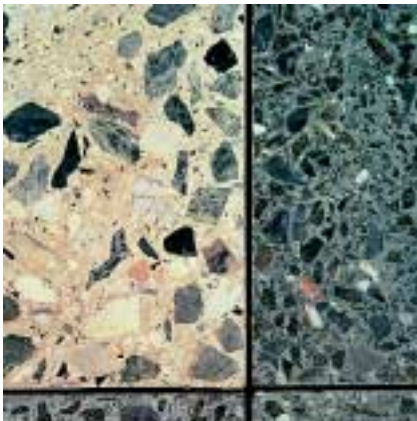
Geschliffene Betonoberfläche, heller und dunkler Zuschlag, grauer und weißer Zement
